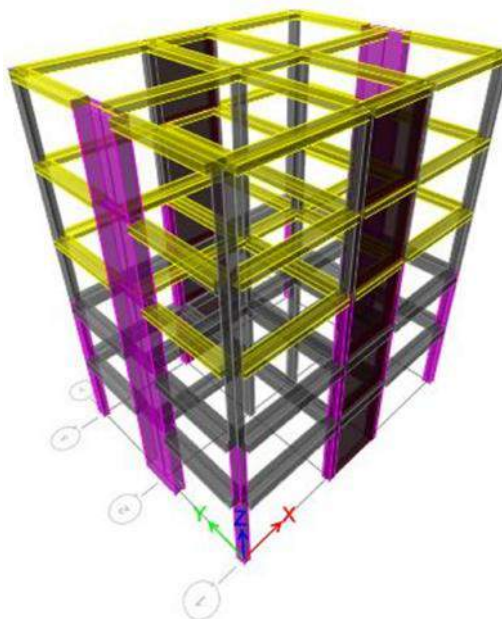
25: Modeli 3d pas shtesës së mureve beton arme
